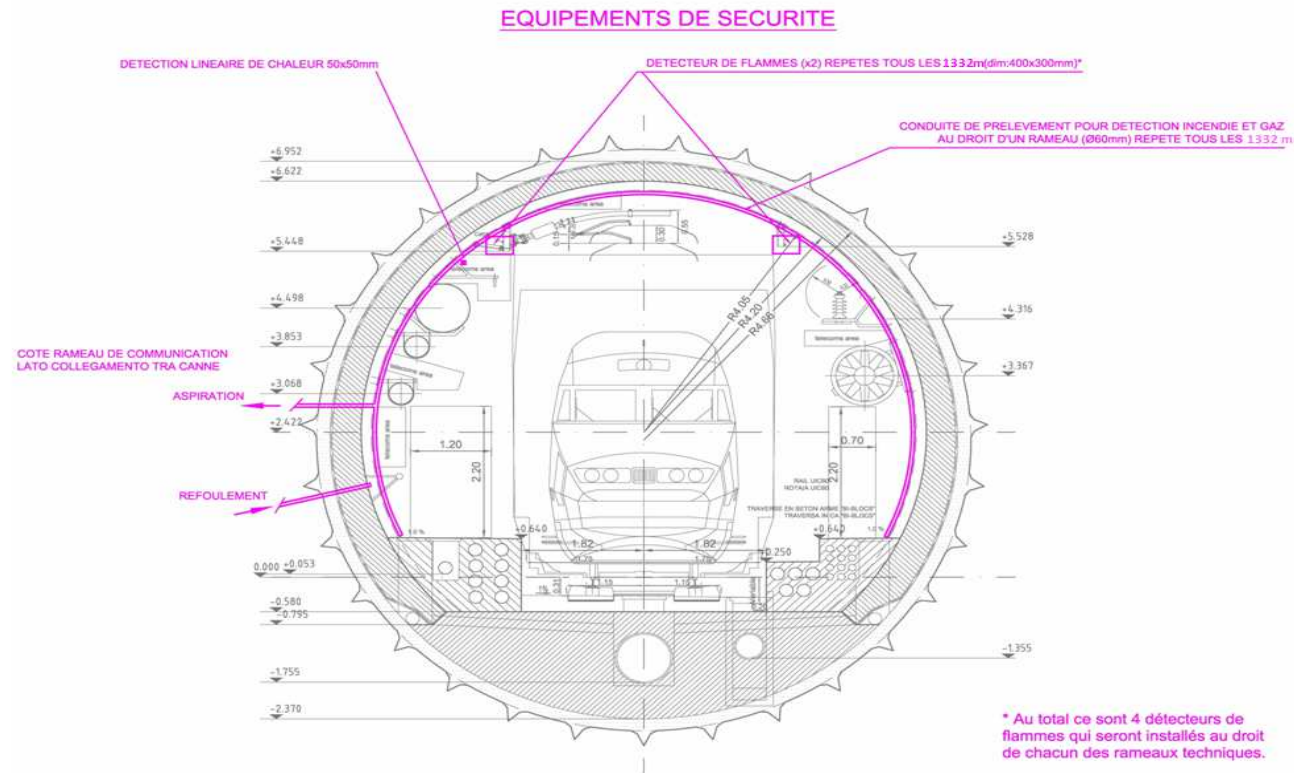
Sezione trasversale nel tunnel per il sistema di rilevamento incendio e gas
